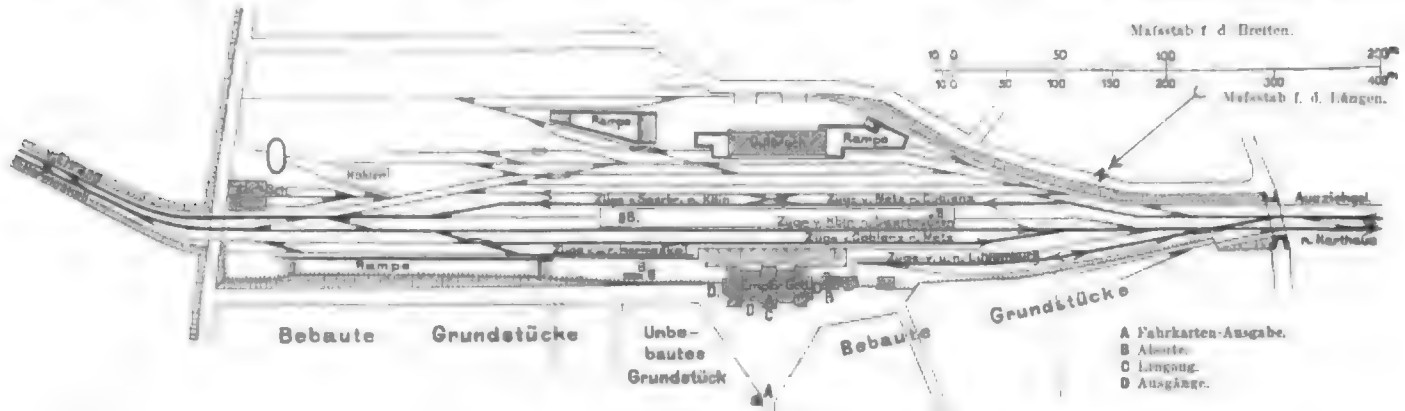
Bahnhof Trier r. M. Allgemeiner Lageplan.
